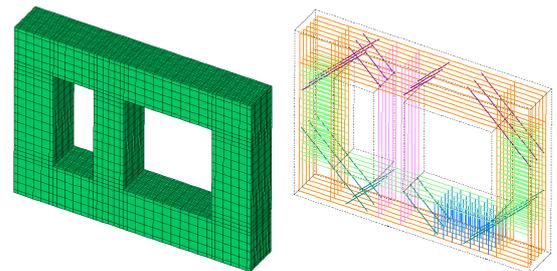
3次元解析モデル(コンクリート要素と鉄筋モデル)
